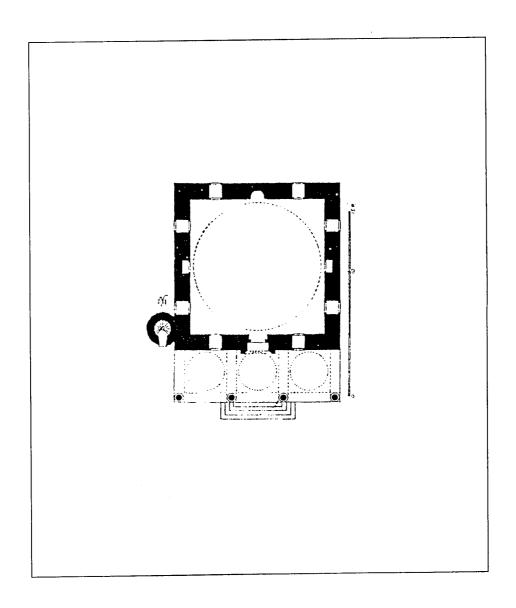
مسقط أفقي لمسجد قاسم باشا في أدرنة (عن : اصلان ابا) .
